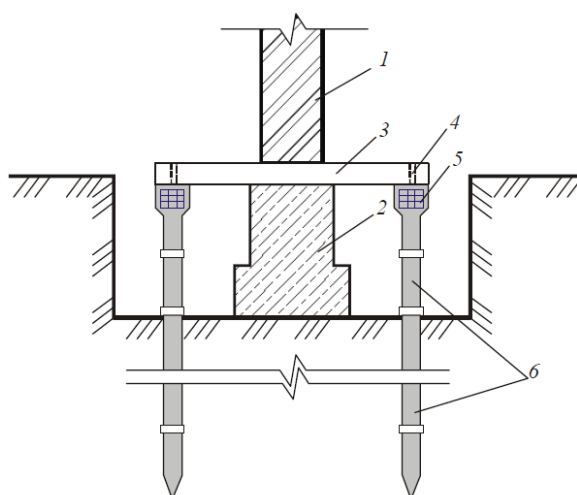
Усиление фундаментов с помощью задавливаемых металлических свай.
